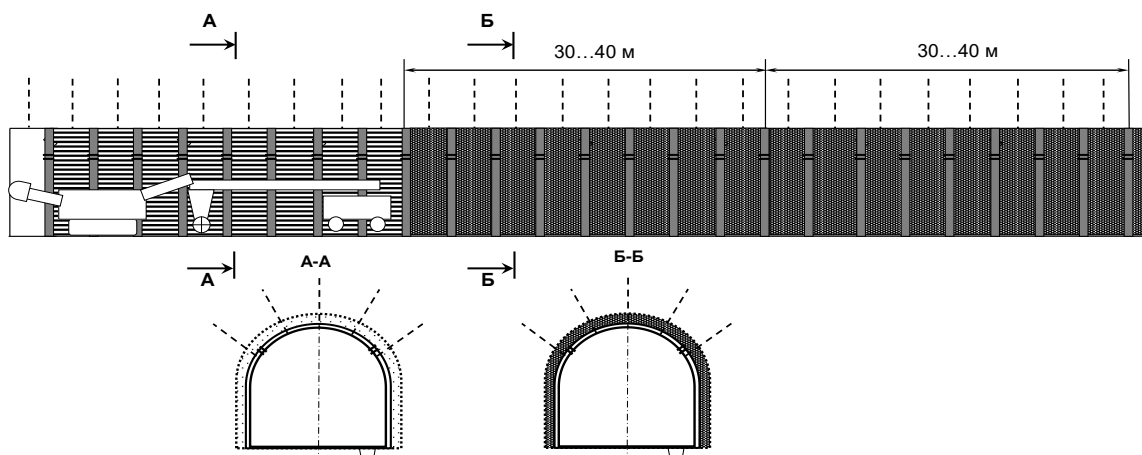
Технологическая схема возведения крепи с установкой анкеров и нанесением набрызг-бетонного покрытия (АСН+А)
